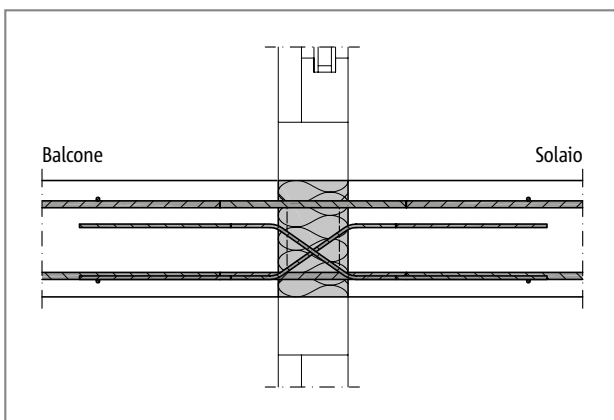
Schöck Isokorb® tipo DXT: sezione costruttiva; solaio monodirezionale
